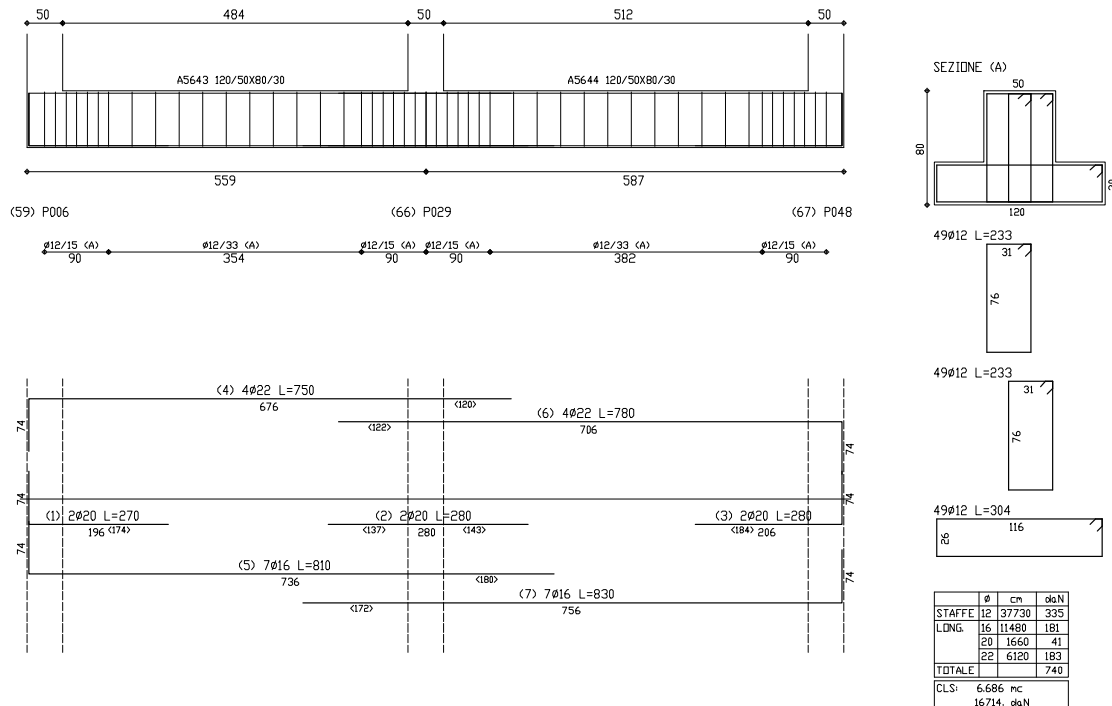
Carpenteria travi di fondazione-Edificio a pannelli
